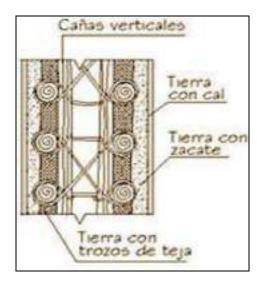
Detalle del muro de bahareque. (Fuente: Hernández, 2014)
